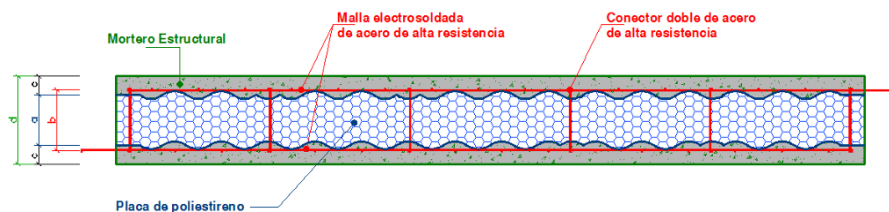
Muros de Hormi2 (DIEDRA 2014)
